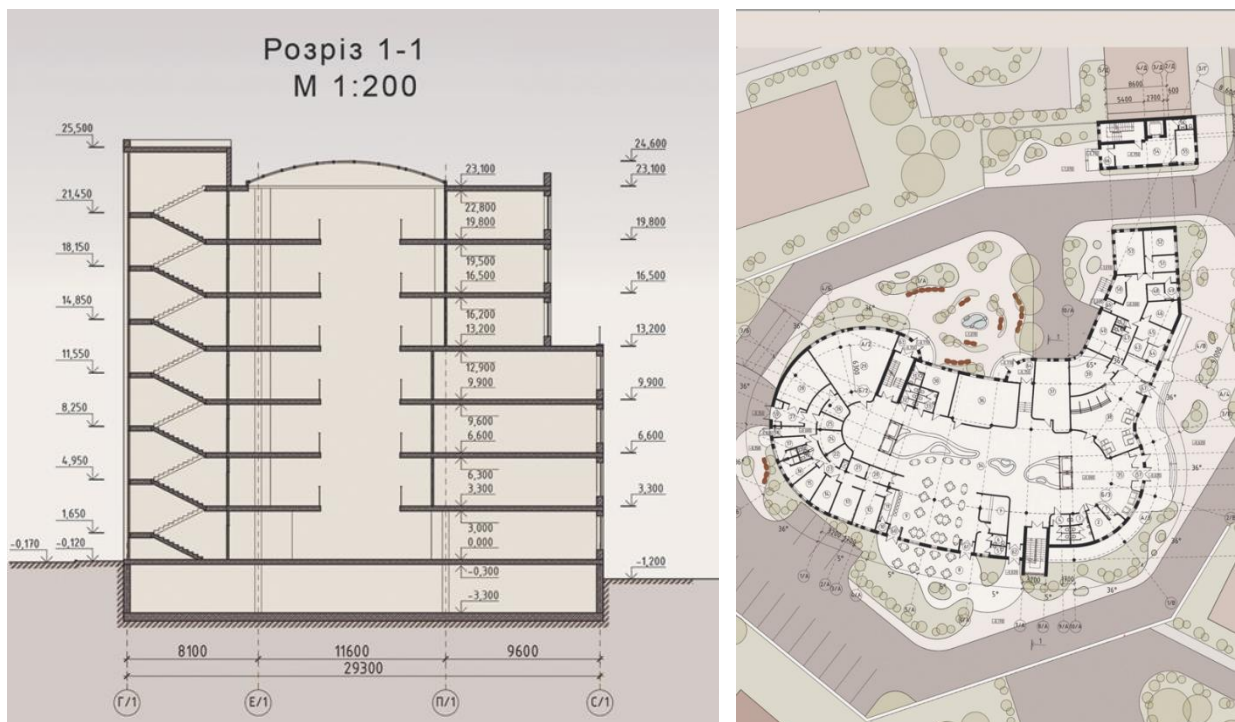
Офісний центр – розріз будівлі та фрагмент плану
